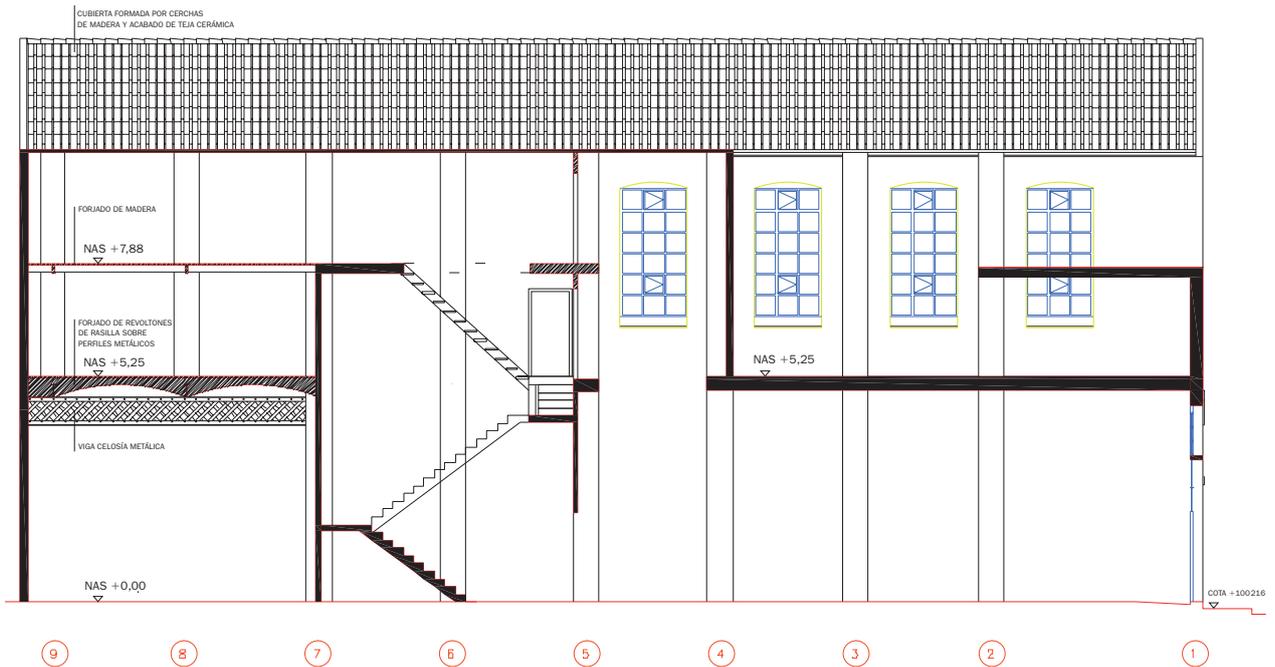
Alçat longitudinal. | Alzado longitudinal.
